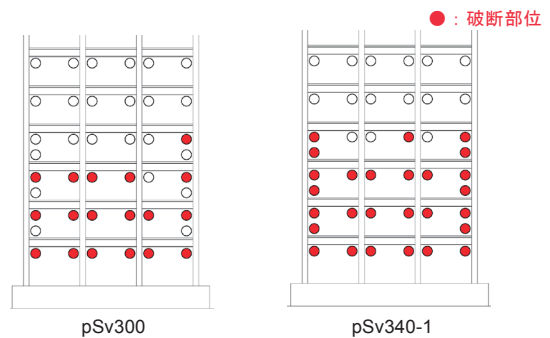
梁部材の損傷状況<sup>5)</sup> (Distribution of Damage to Beams)
